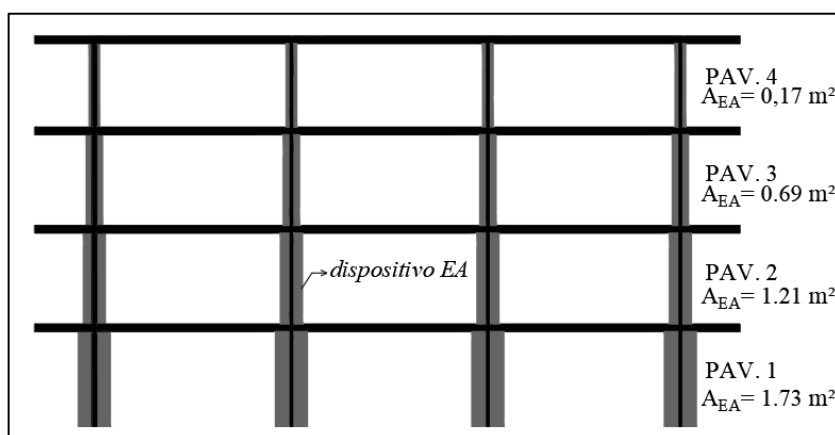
Relação de área e massa do dispositivo EA para cada pavimento do pórtico em análise, considerando uma distribuição uniforme de massa.
